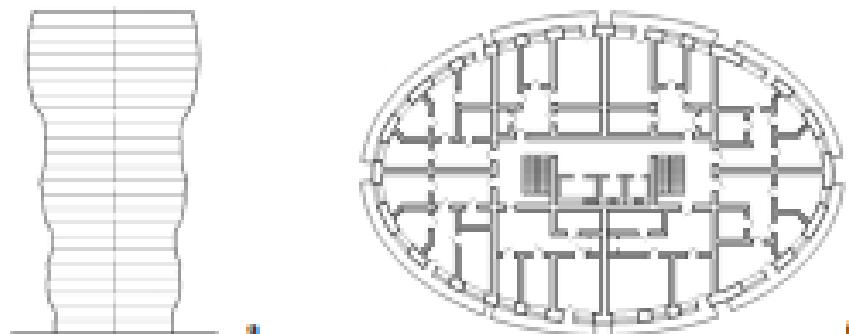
Схематическое изображение: а) стен фасада; б) помещений 16 этажа.
